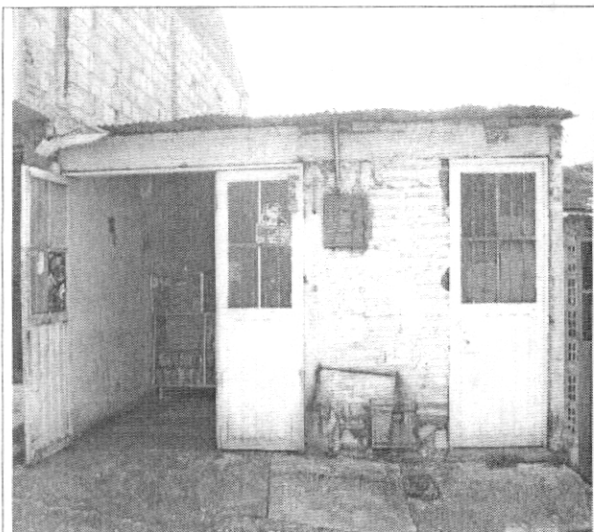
Fachada de la vivienda Trans 5 F # 44 A 56 Sur
